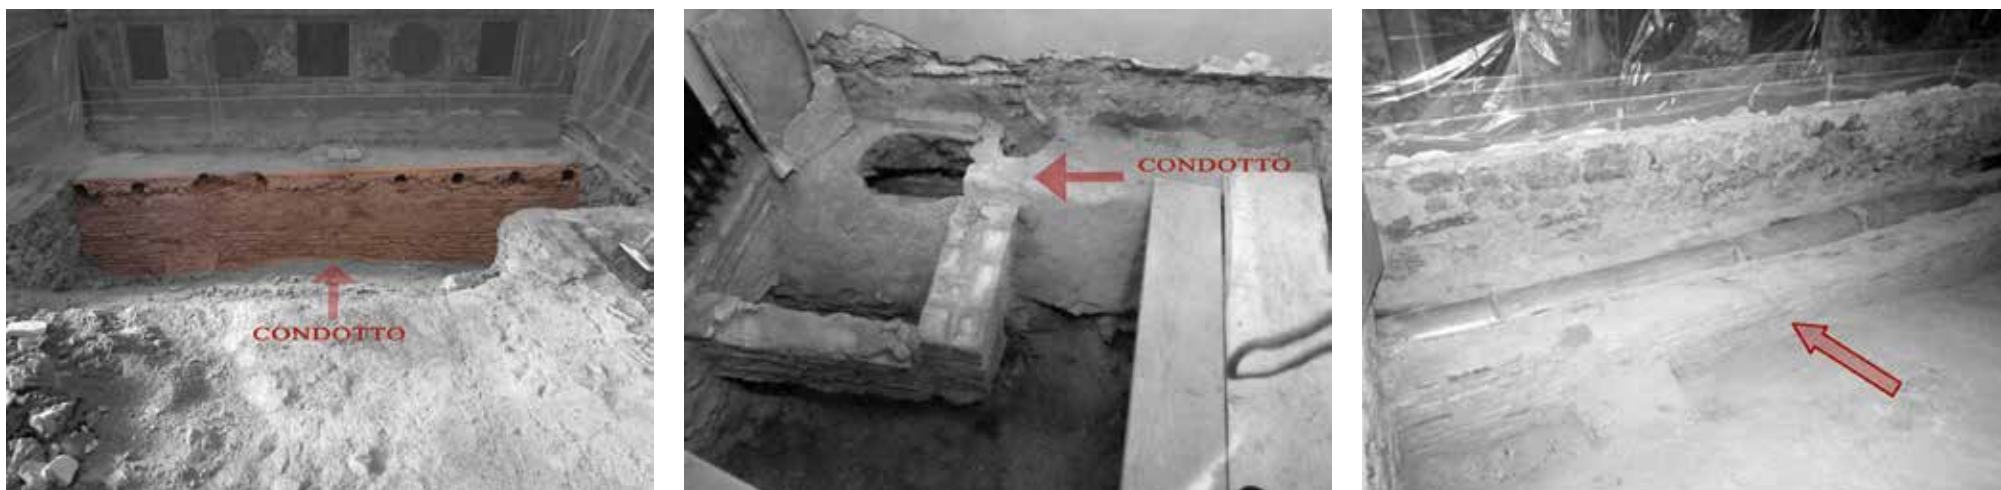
Da sinistra, Altarino coperto della pavimentazione preesistente in marmo rosso e condotto in travertino posto al di sotto del pavimento
